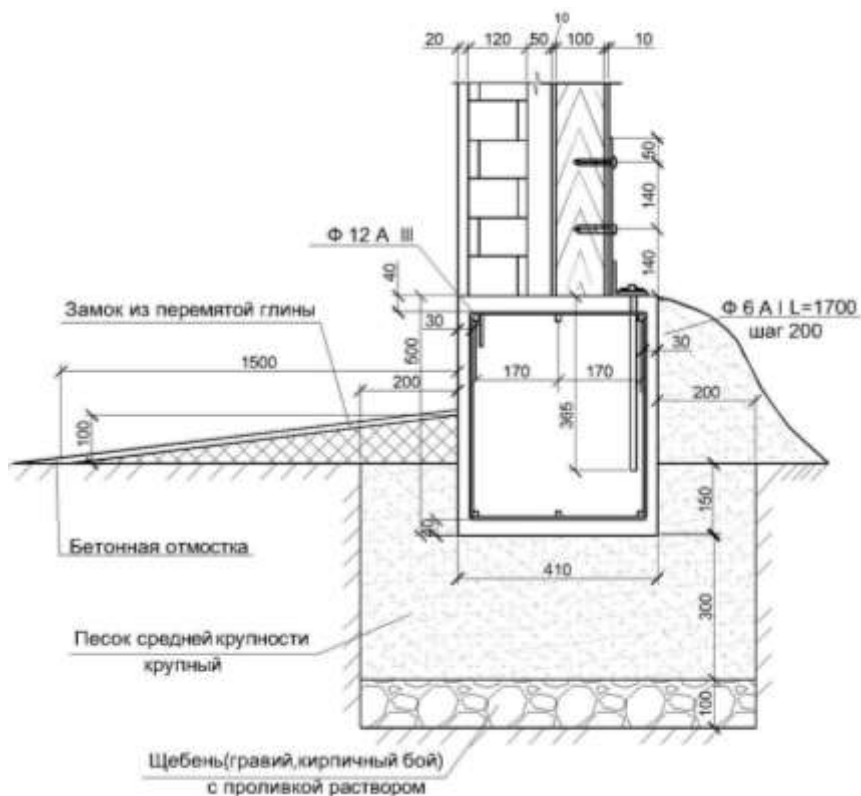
Фундамент с анкерным креплением несущего конструктива посредством уголковой стали и металлических пластин
